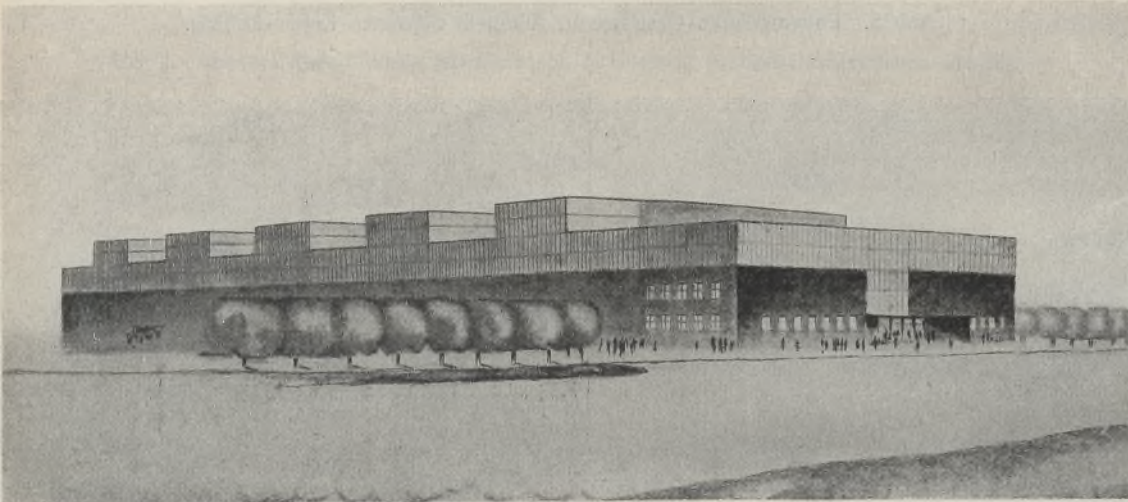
Ausführungs-Entwurf Breest & Co., Architekt Schiemichen-Leipzig (vergl. Abb. 1 u. 11).
